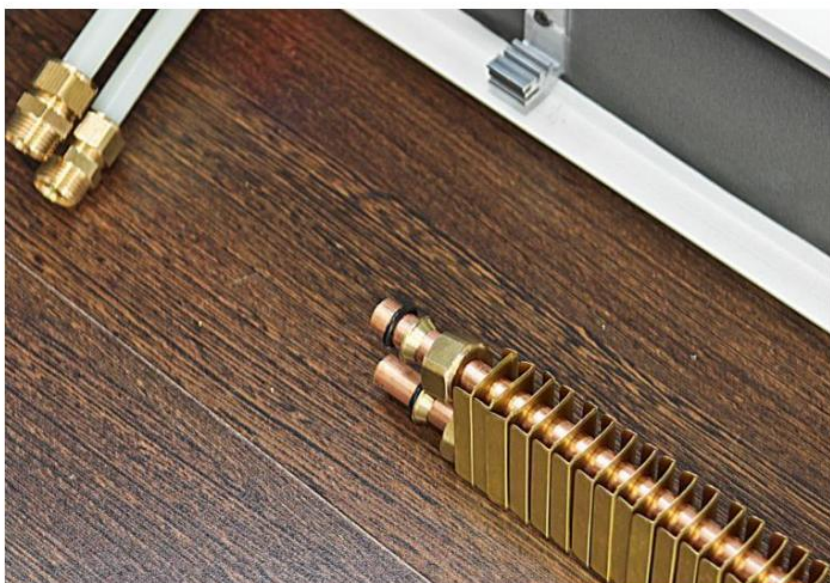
Подготовка греющего модуля к присоединению – снимается две – три ламели с краю, на трубки надеваются подсоединительные гайки, опрессовочные конусы и резиновые прокладки фитингов
